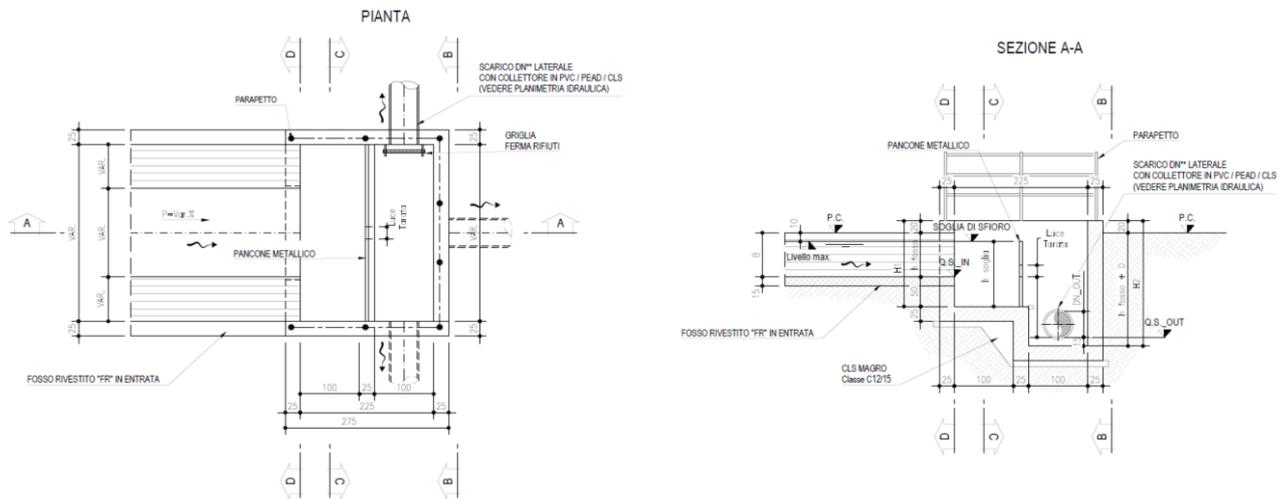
Sezione tipologica dei manufatti di regolazione e scarico tipo “MC2”.
